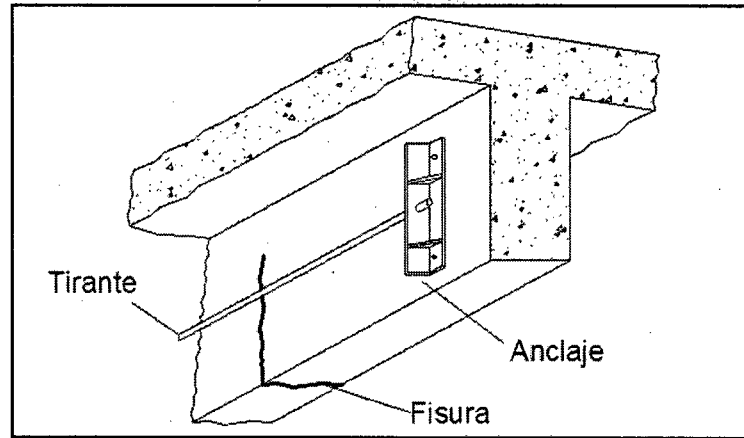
Reparación de fisuras en una viga con tirantes.
